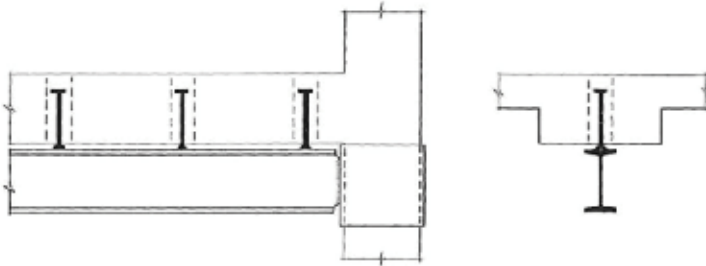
Refuerzo mediante conversión de una sección de hormigón en mixta (Fuente: González y Díaz, 2000)
